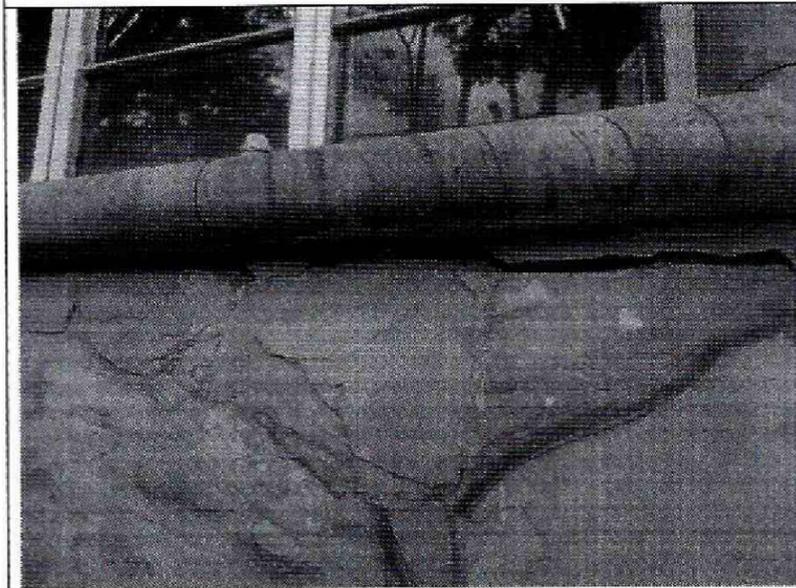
Grieta en acabado y mampostería de la fachada, primer nivel
